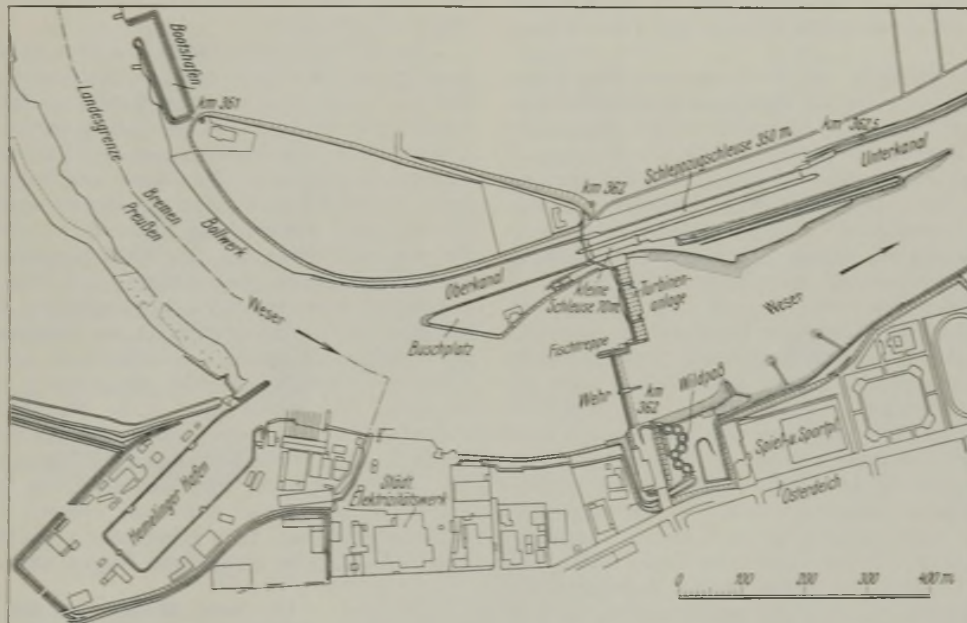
Lageplan der Wehranlage in der Weser bei Bremen.
